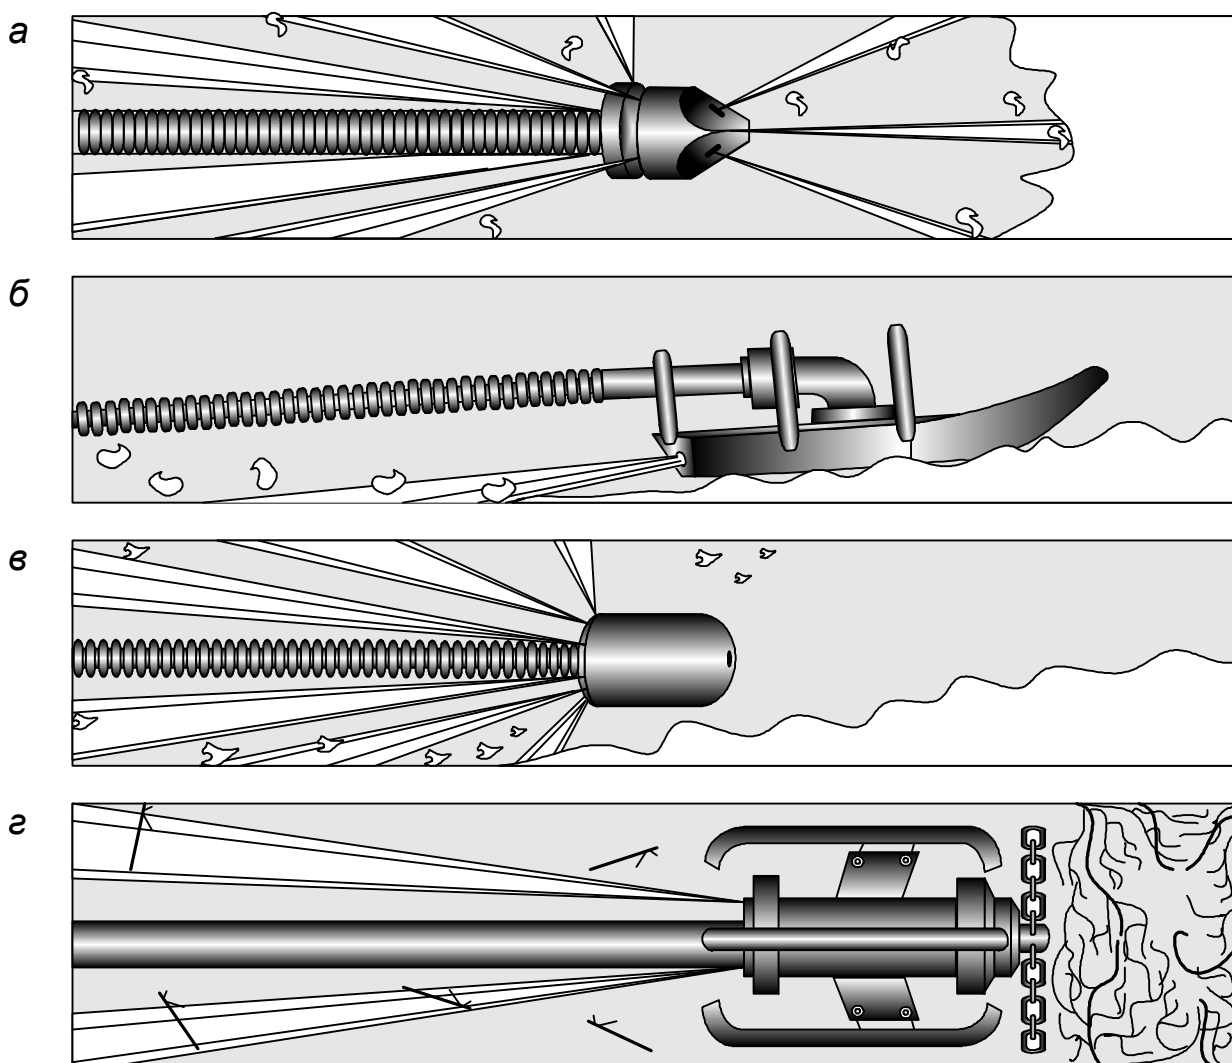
Пример работы насадок: а – насадка для устранения закупорок сети; б – насадка для очистки донных отложений; в – универсальная насадка; г – насадка для обрезки корней деревьев
